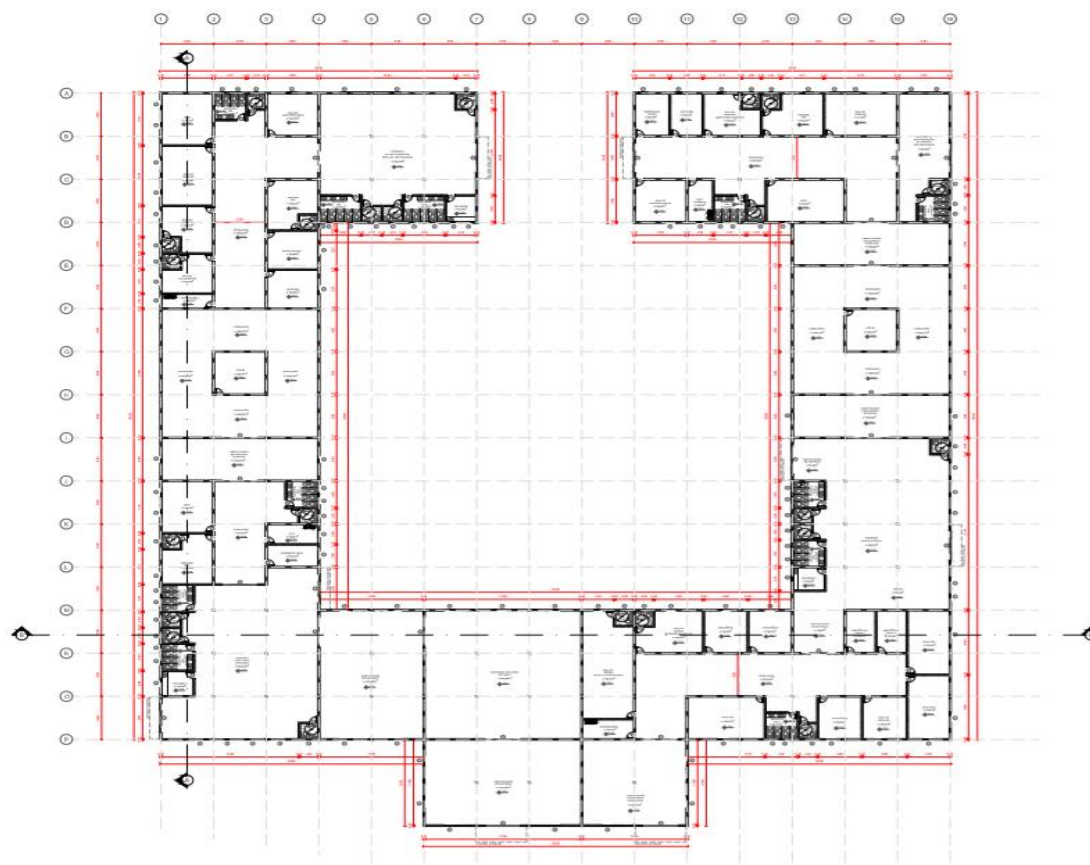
Planta Técnica – Fonte: Acervo Próprio
